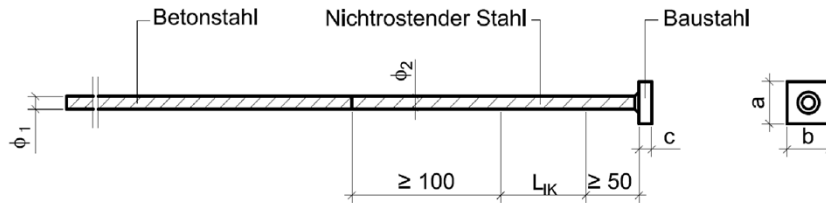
Druckelement aus Stahl mit angeschweißter Druckplatte und angeschweißtem Betonstahl
